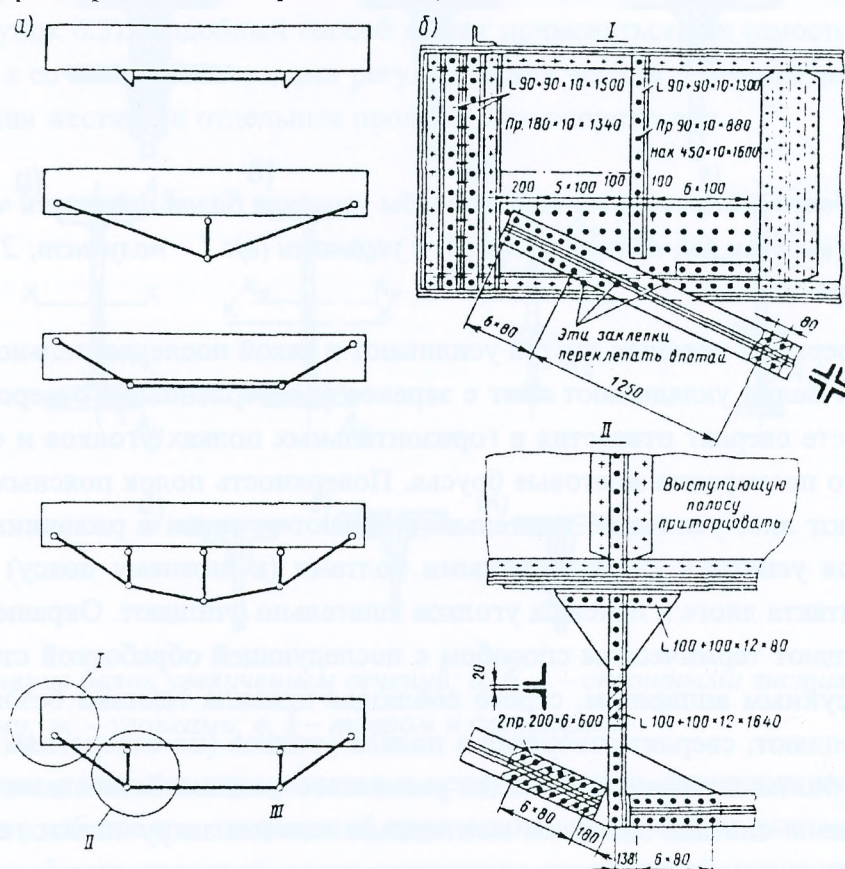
Усиление балок шпренгелями: а – схемы усиления, б – конструкция узлов.
